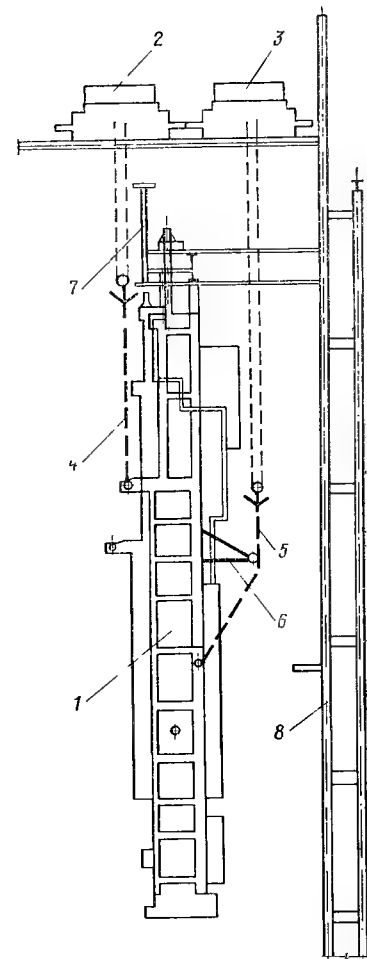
Установка блока каркаса боковой стены топki в проектное положение.
